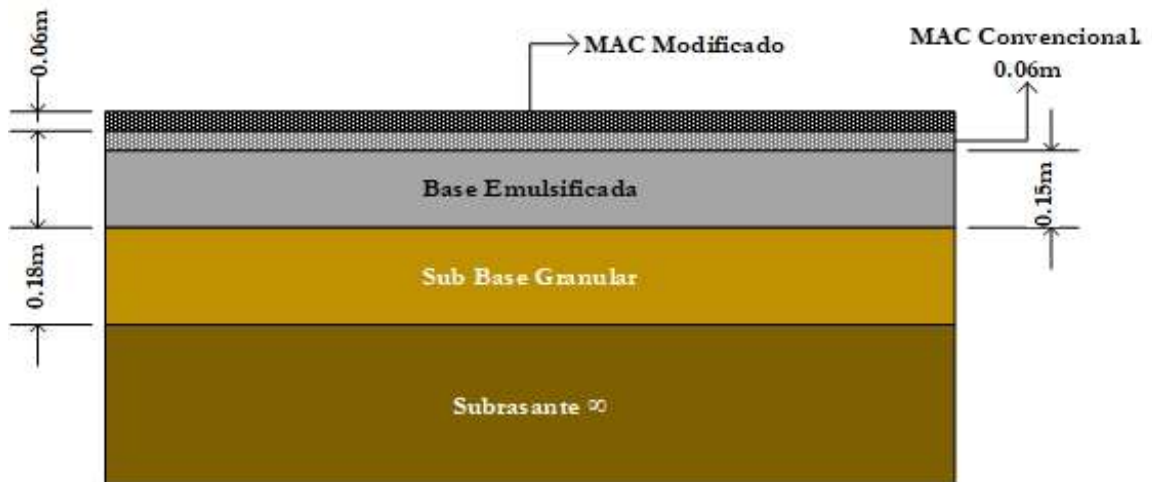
Estructura pavimento Bypass San Miguel
